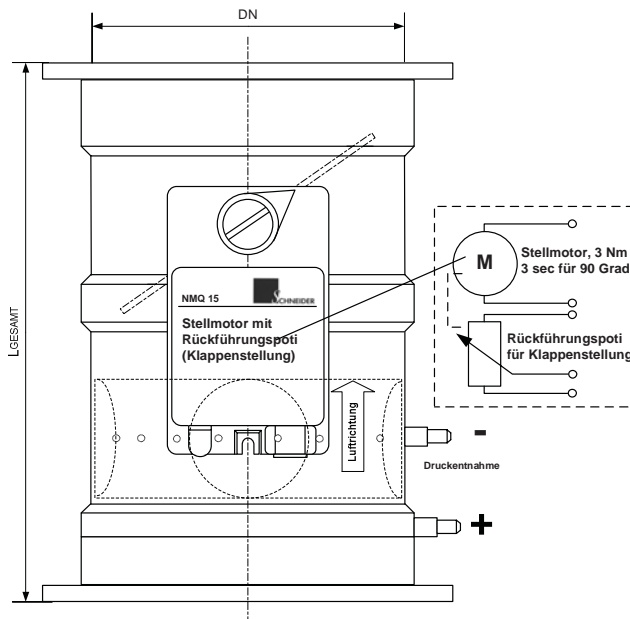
Anschlussschema Stellmotor mit Rückführungspotentiometer
